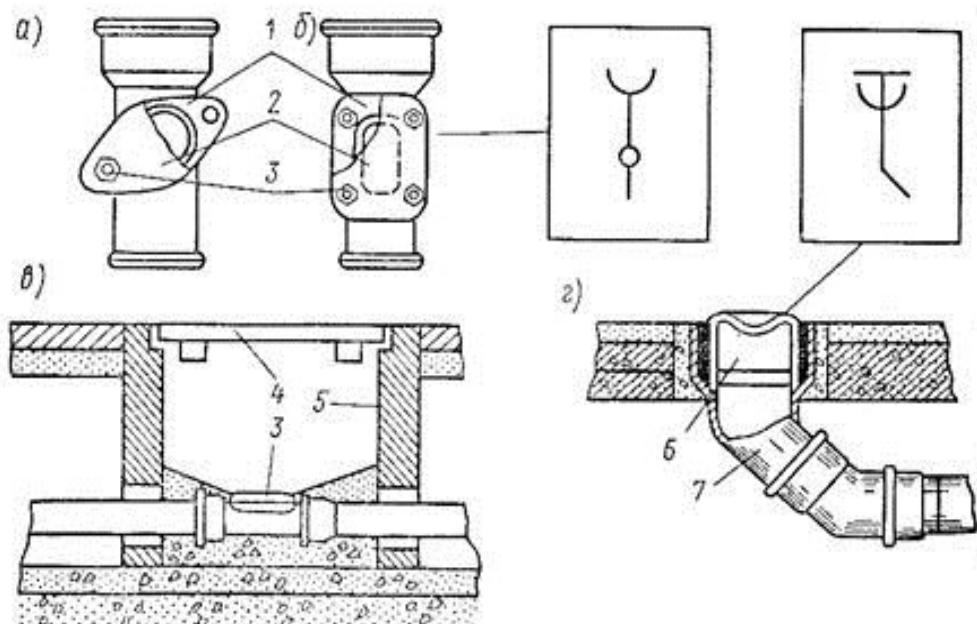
Ревизии (а, б, в) и прочистки (г): 1 – резиновая прокладка; 2 – крышка; 3 – болты; 4 – крышка колодца; 5 – колодец; 6 – заглушка; 7 – отвод.
